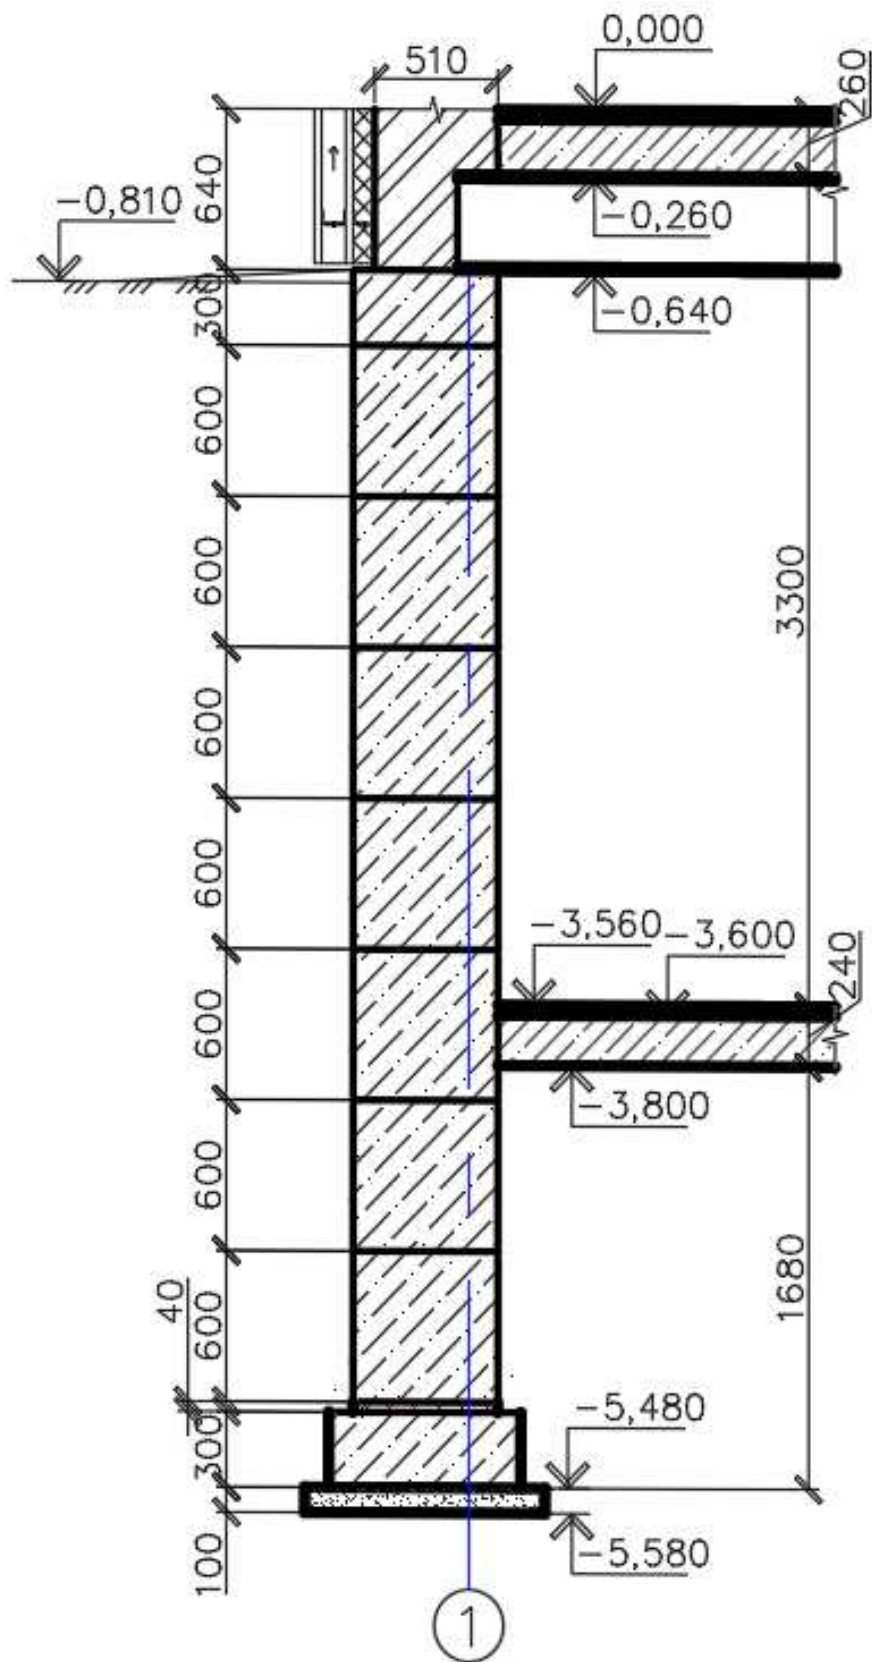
Схема к определению размеров подошвы ленточного фундамента
